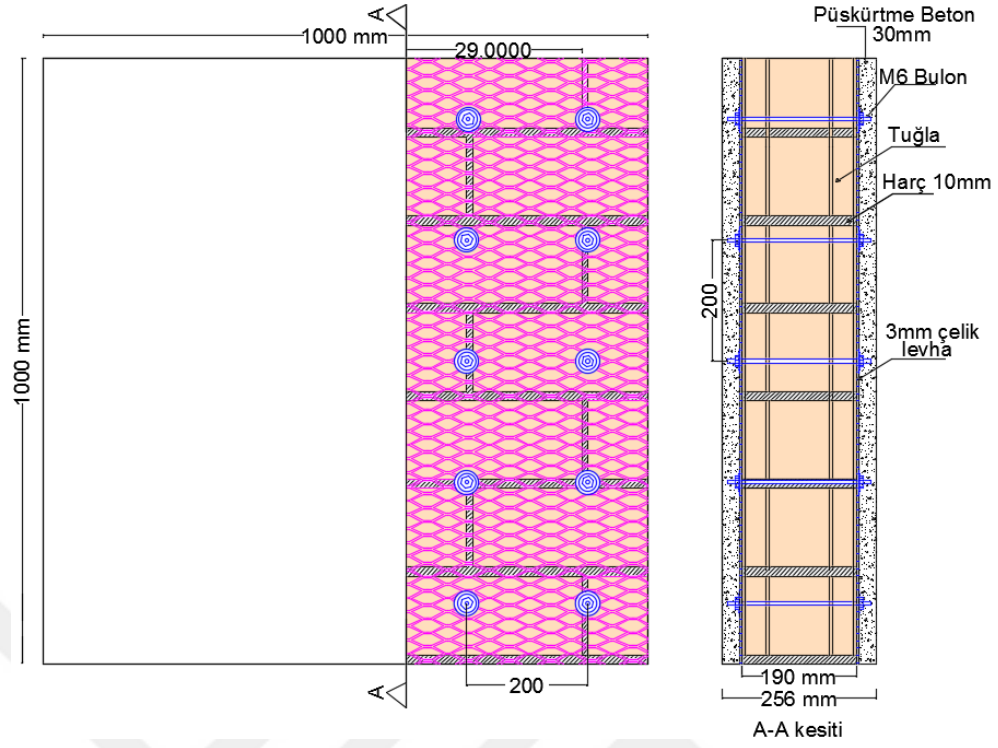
RS Deney elemanı püskürtme betonlu
